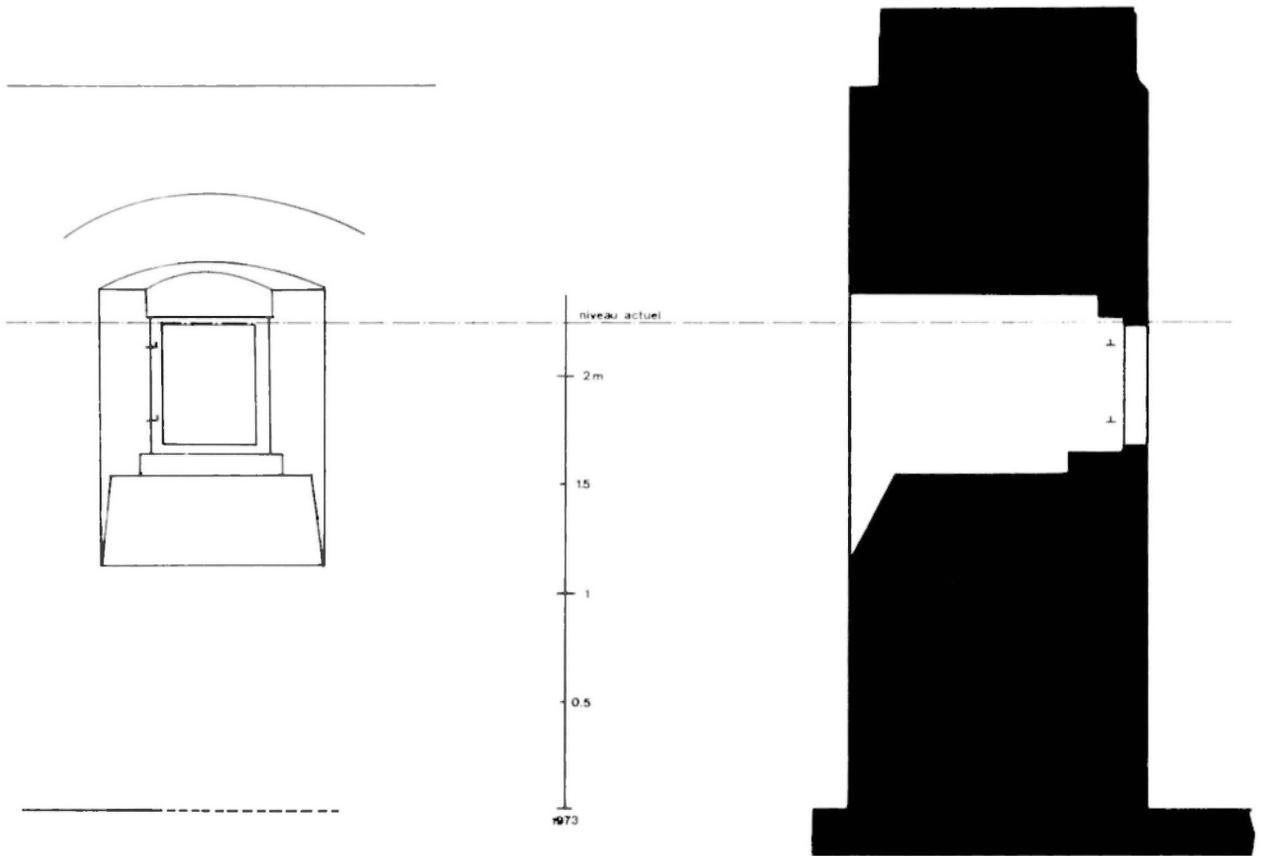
« Chapelle ». Rez-de-chaussée : élévation et coupe de la fenêtre est.
